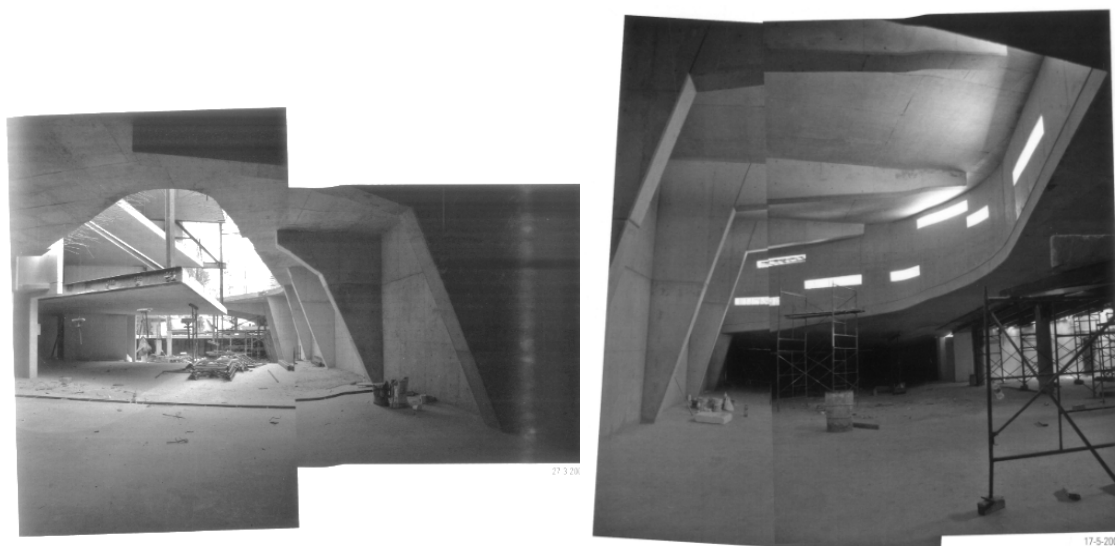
Imágenes de las ménsulas en planta de sótano. Documentos de Arquitectura nº 60. Revista del Colegio de Arquitectos de Almería.
